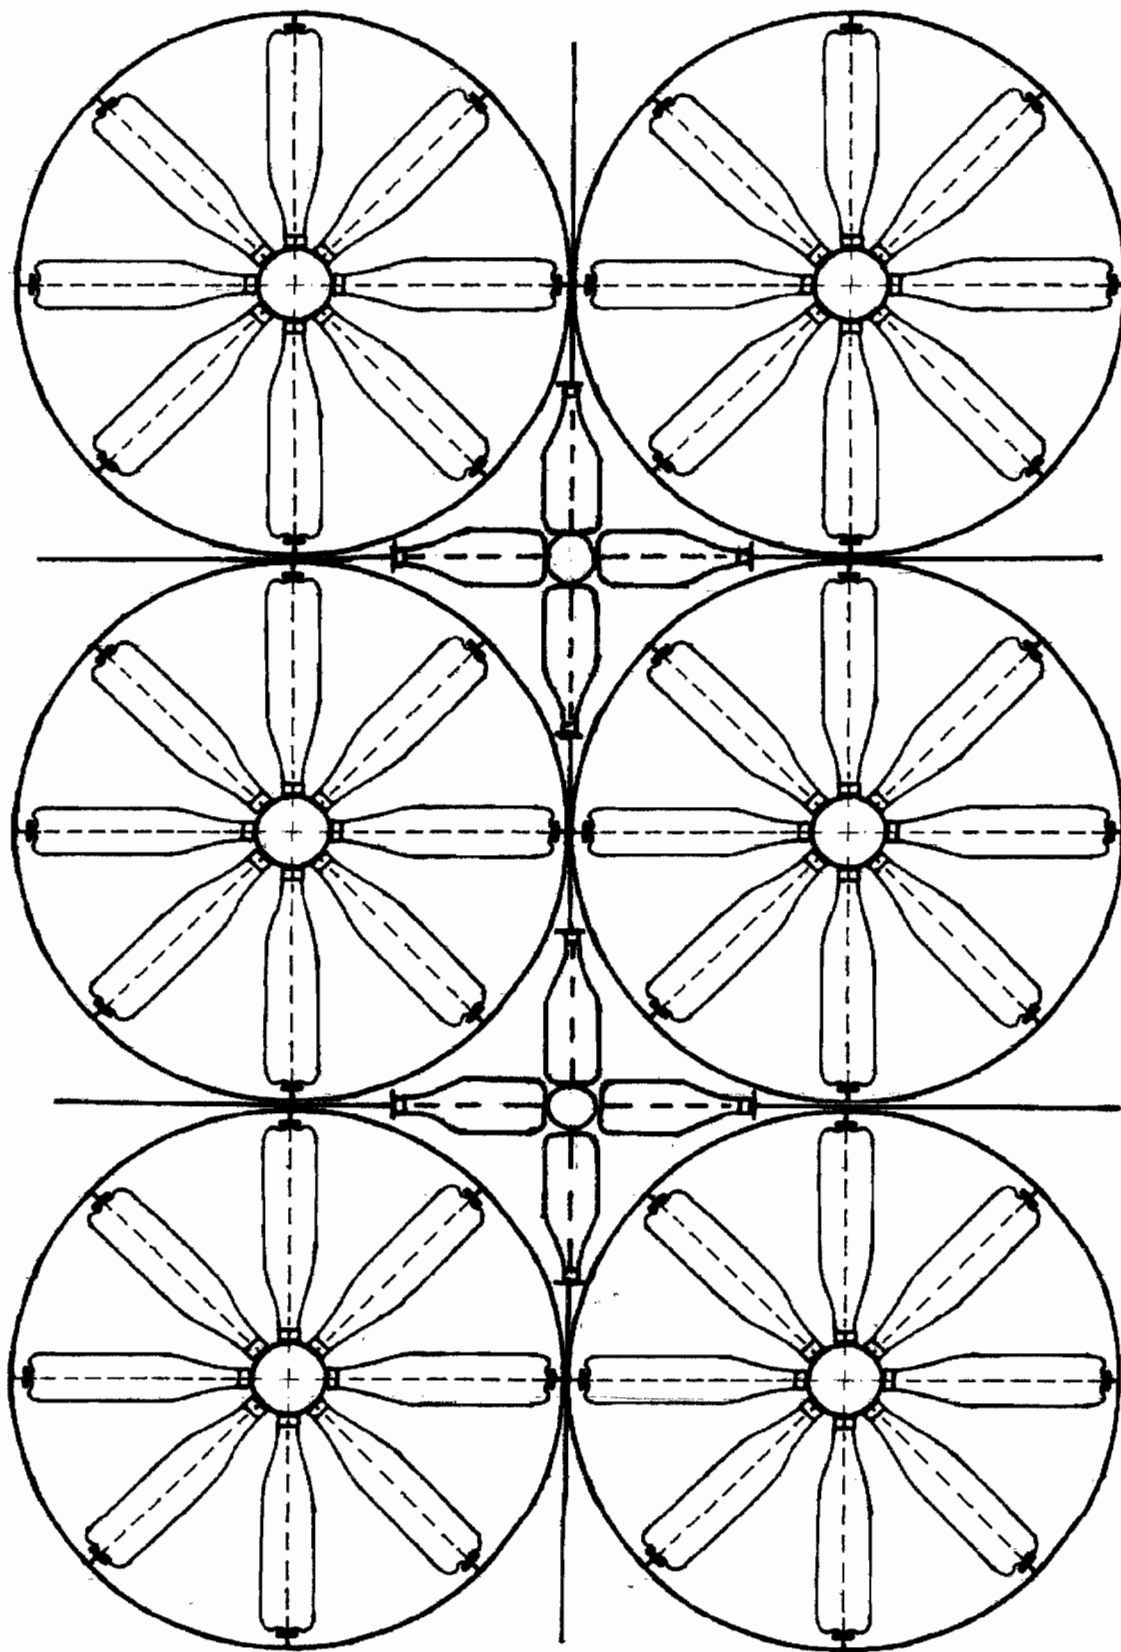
Model de gard alcatuit dintr-un ansamblu de 6 elemente modulare de constructie
